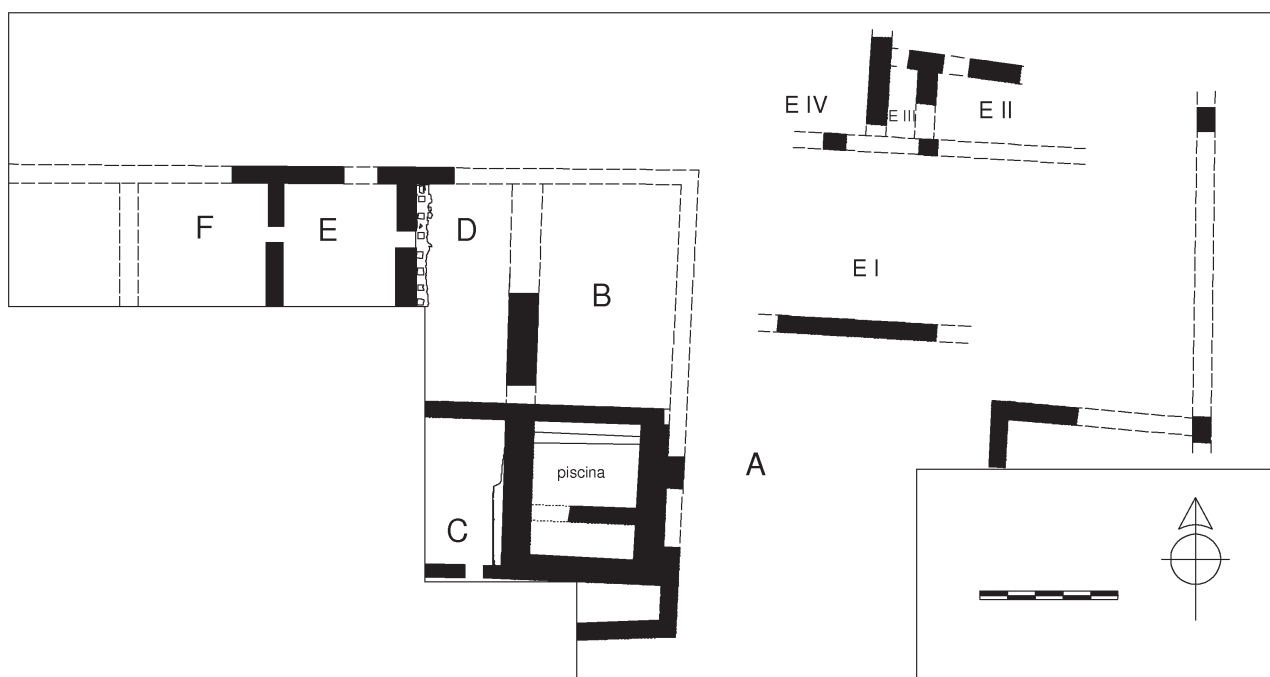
Planta de las termas de la calle Tapinería. Fase I.
